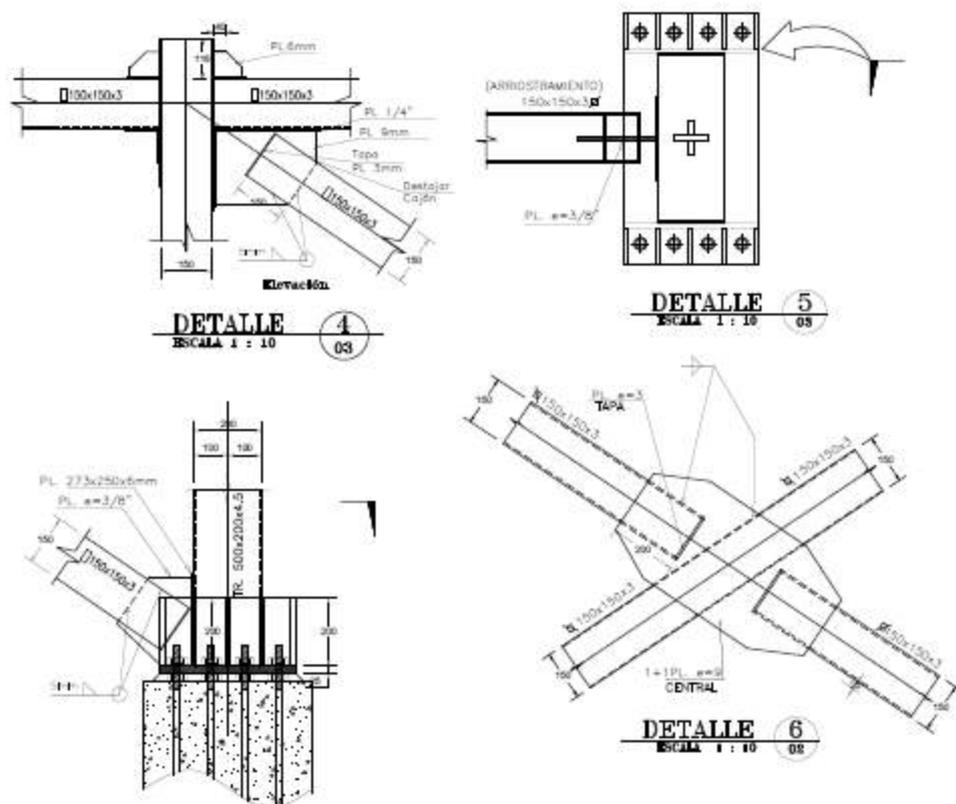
Detalles en 2D de las uniones y anclajes con soldadura.
